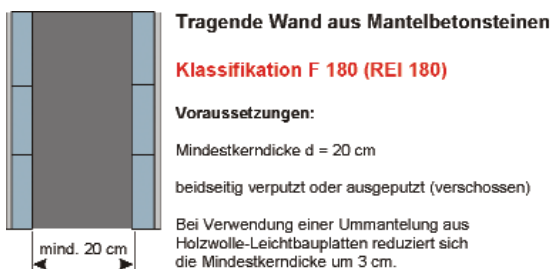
Ausführungsbeispiel einer tragenden Wand aus Mantelbeton
